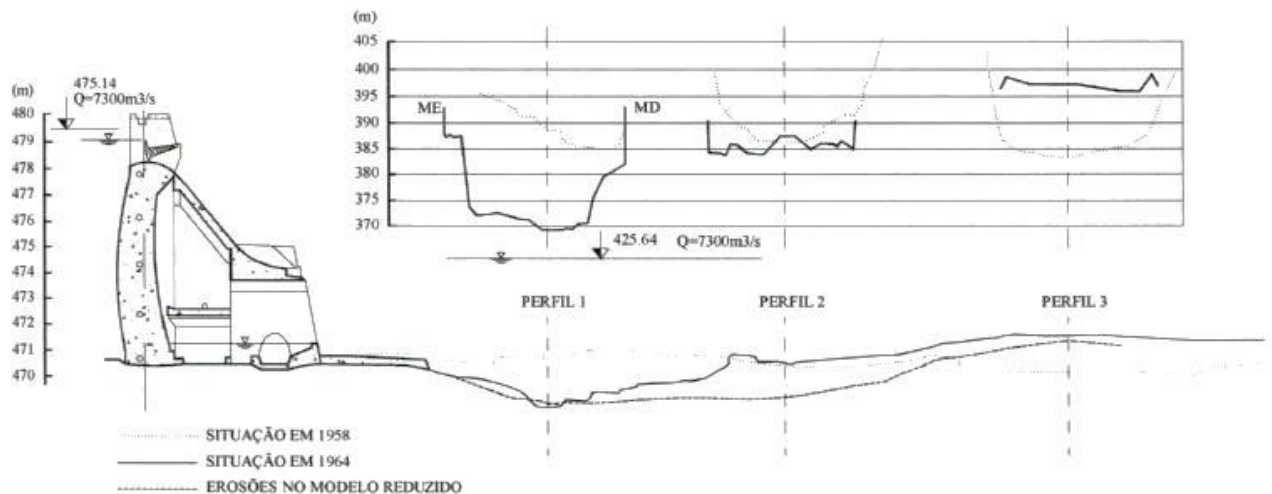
Perfil de erosão da barragem de Picote (Melo, 2002).
